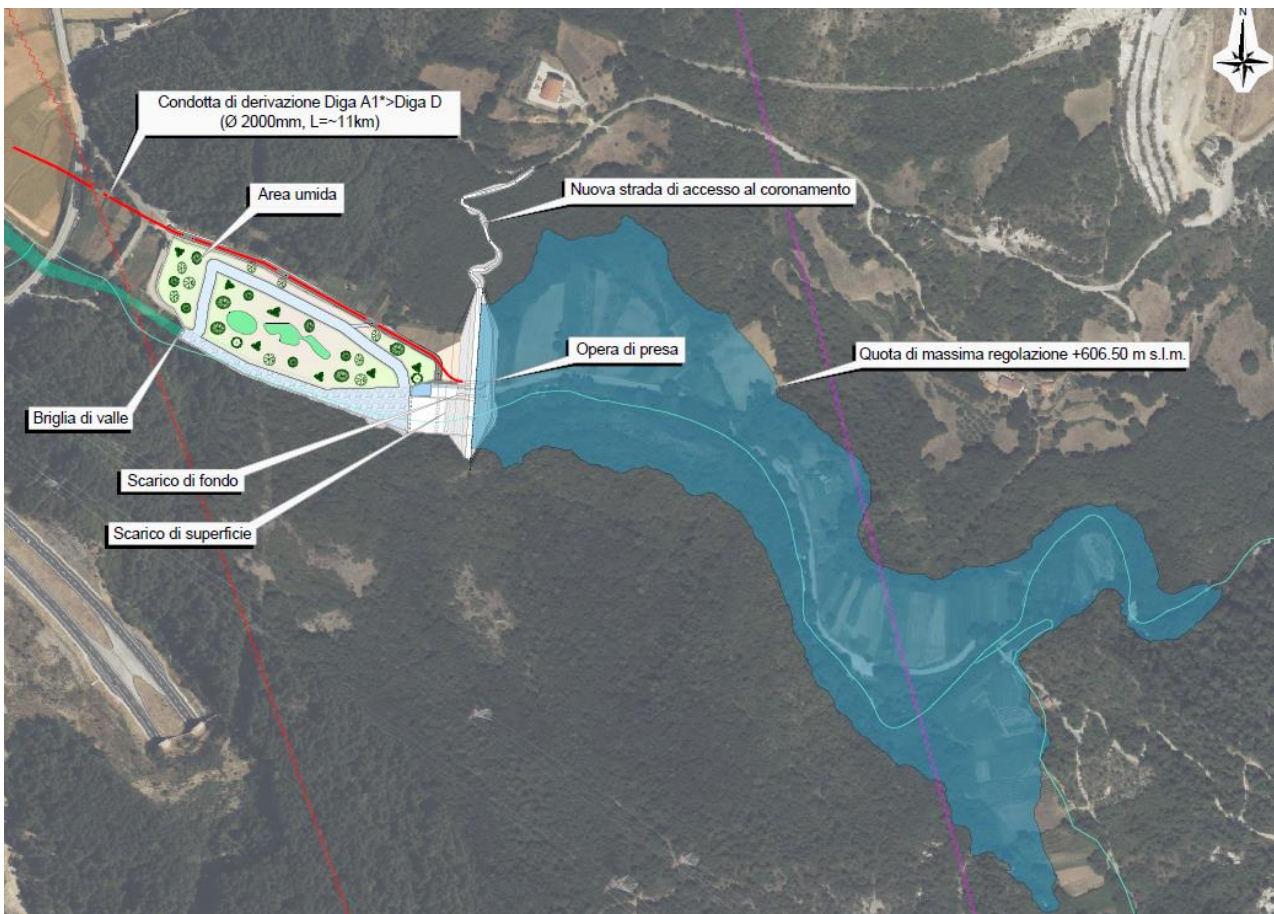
Alternativa 1 (A), planimetria generale di progetto sito A (fonte DOCFAP, 2024)
